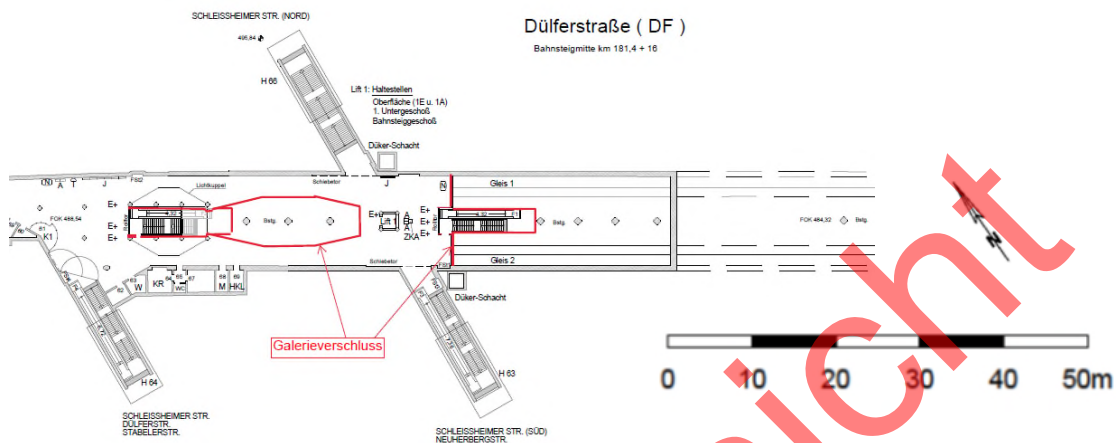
Grundriss Sperrengeschoß, Galerieverschluss
